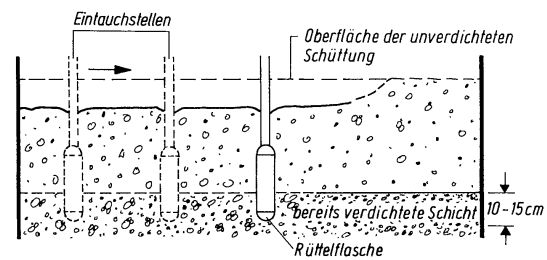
Richtiger Einsatz von Innenrüttlern
